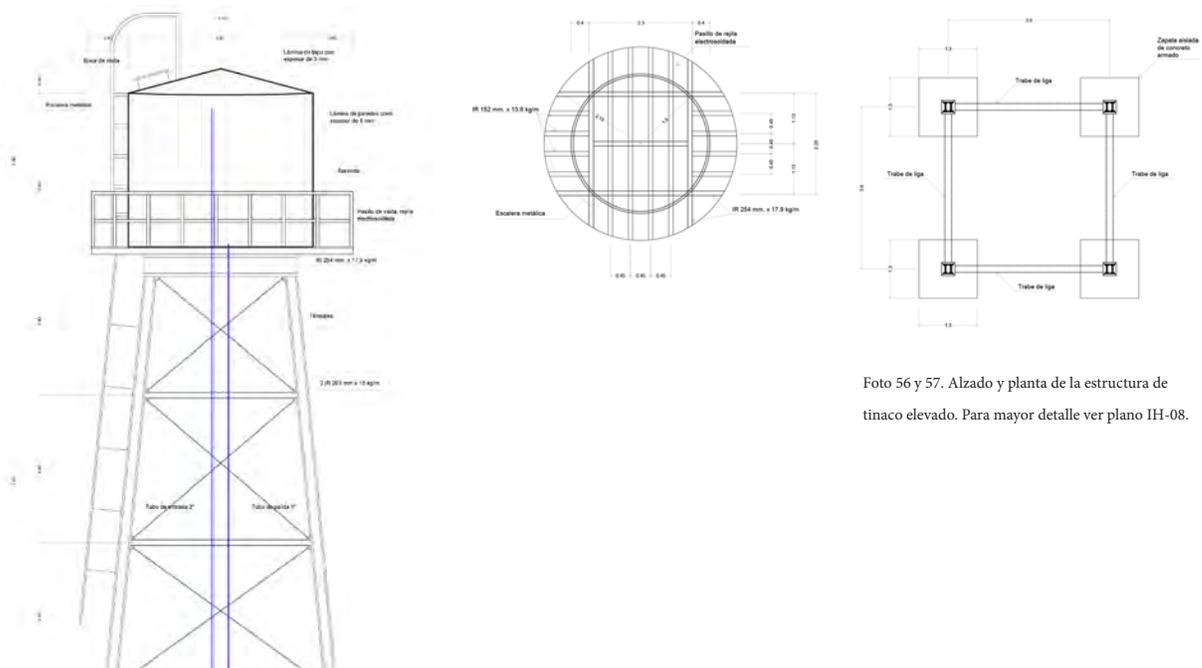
y 57. Alzado y planta de la estructura de tinaco elevado. Para mayor detalle ver plano IH-08.
